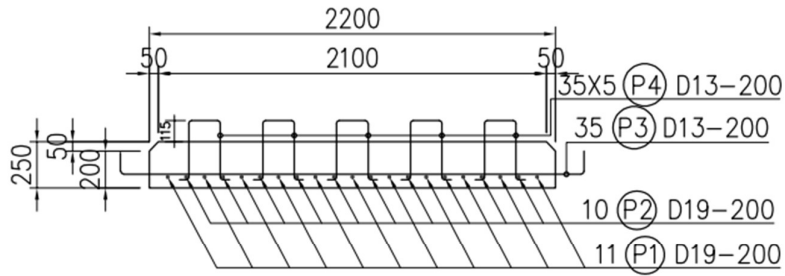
Detail Penulangan *Half Slab* Tebal 25 Cm
